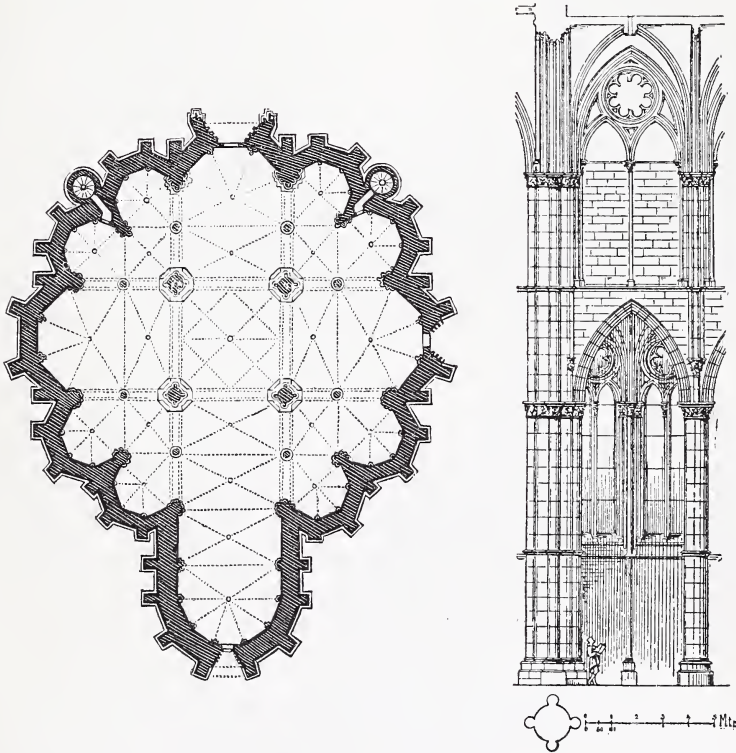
u. 344. Grundriss und System der Liebfrauenkirche zu Trier.
